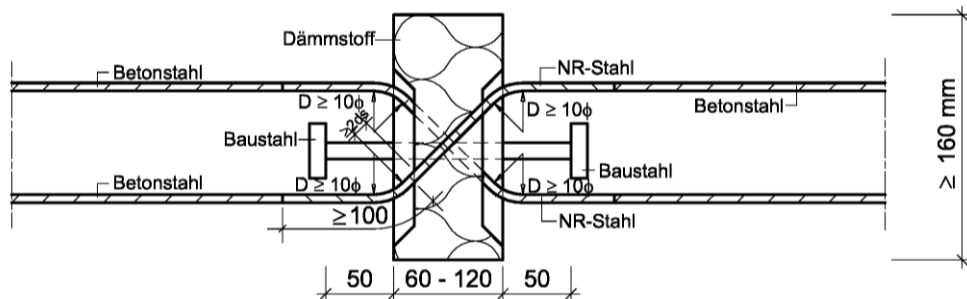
Schöck Isokorb[®] Typ Q + Q
